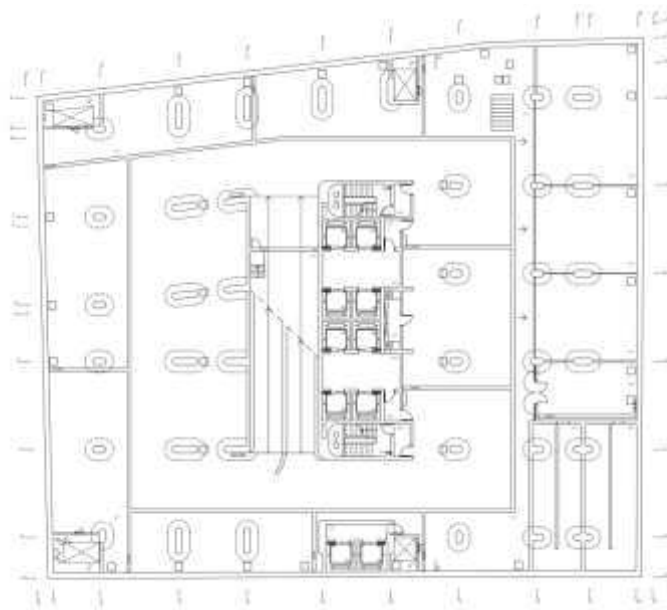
Planta dos piso -2 a 5 (Autor, 2017)
